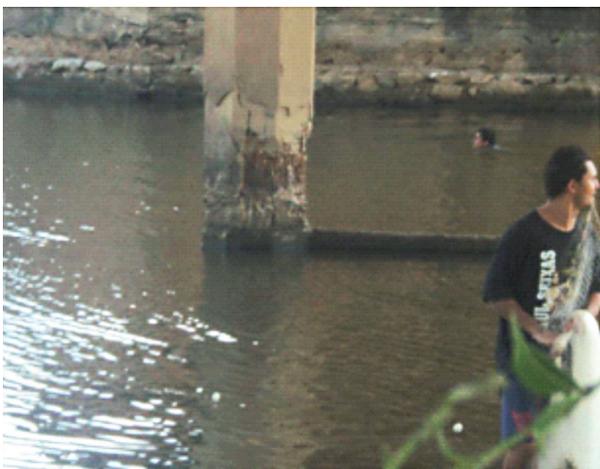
Ruptura da viga de amarração e grande excentricidade dos tubulões.
